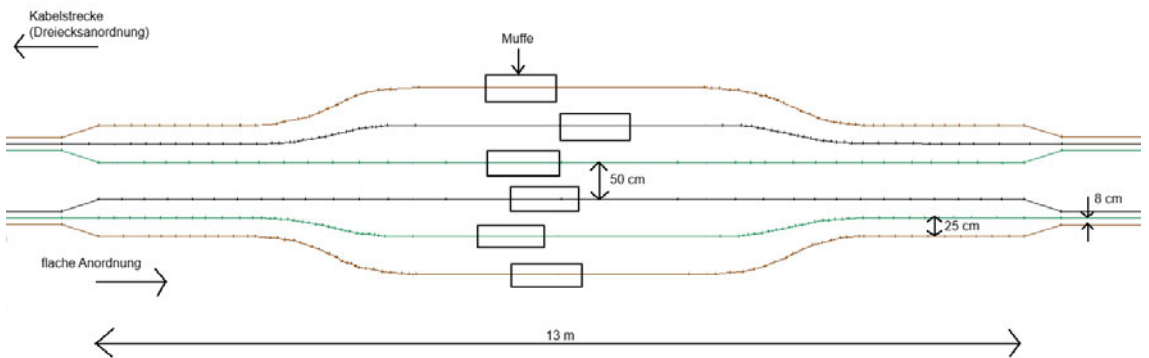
Montageskizze 1800-mm²-Muffe - Draufsicht
